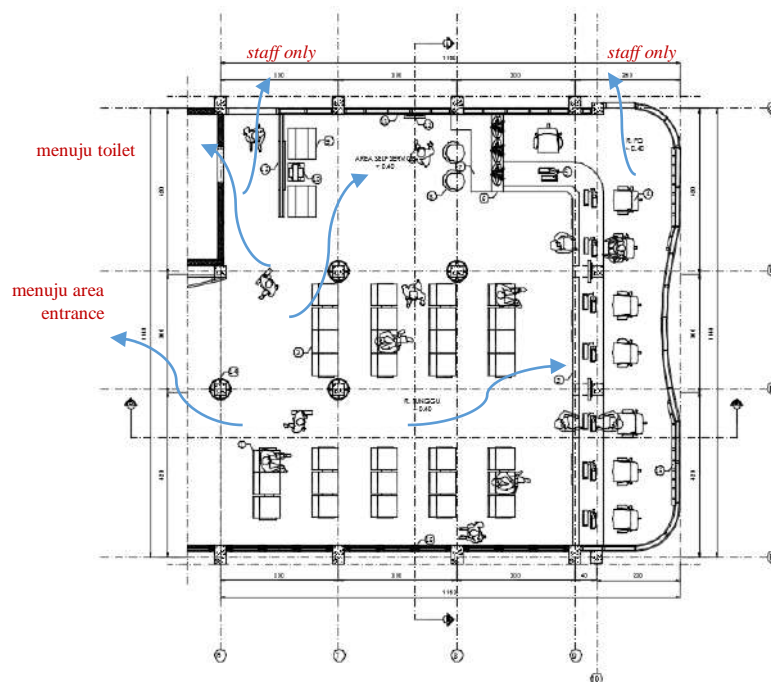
Denah Keseluruhan Lantai 1 dan Denah Ruang Terpilih 2
